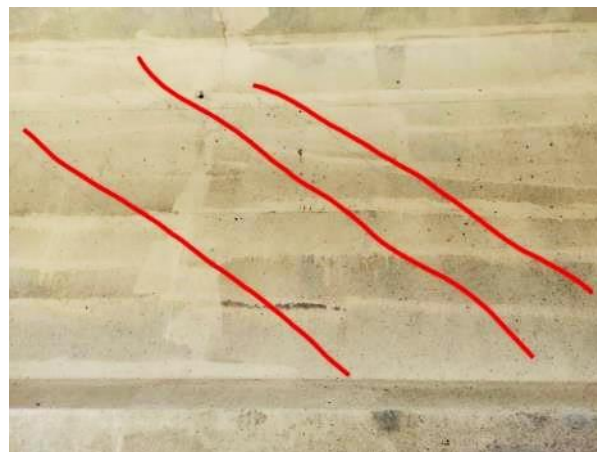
Fisuración diagonal en alma de viga 3 sobre pila P-2, vano 3. Sentido Orense.
